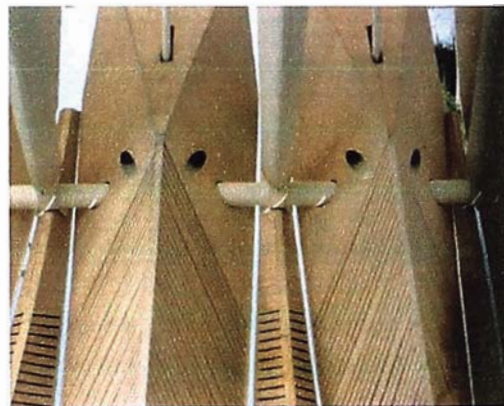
Detalle del Pabellón de Kuwait Sevilla, España
